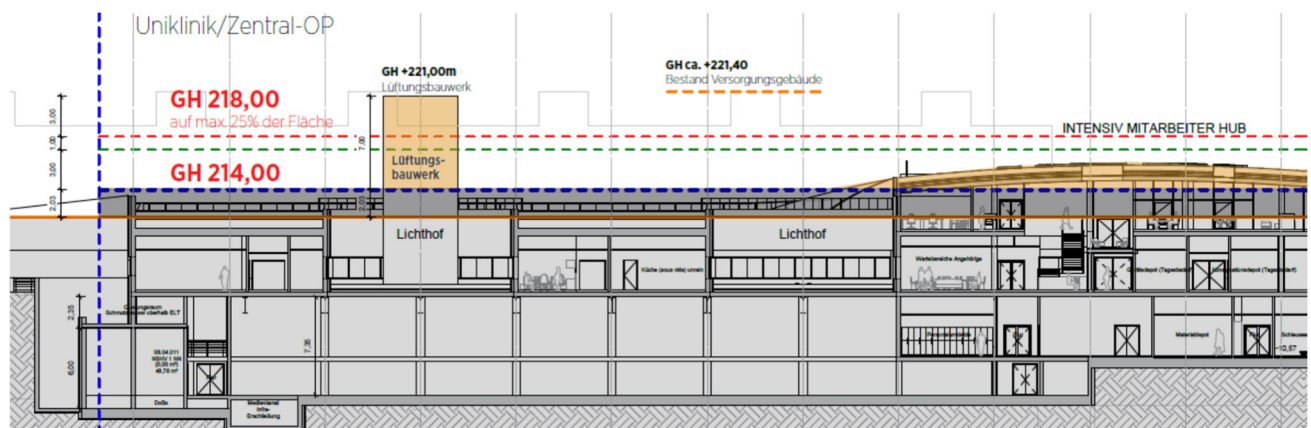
Schnitt (Ausschnitt) mit Lüftungsbauwerk
